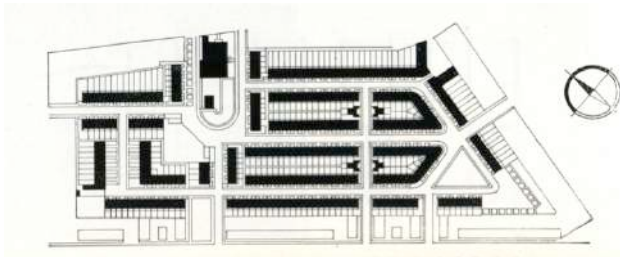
Planimetria e vista del quartiere Kiefhoek a Rotterdam di Oud.
